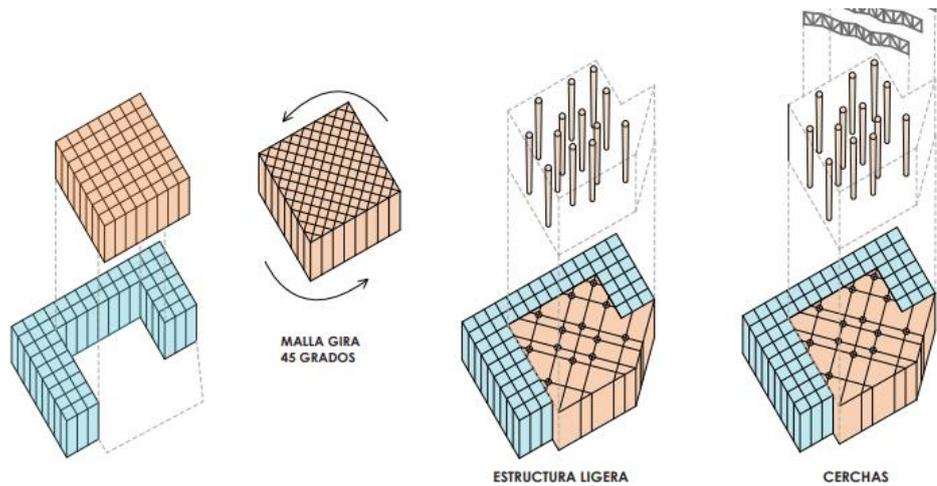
Diagrama Estructuras. Elaborado por grupo de estudiantes Taller Avanzado
